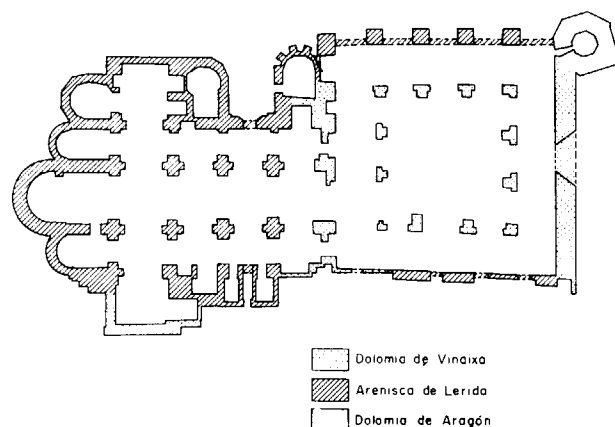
Esquema en planta de la Seu Vella con la distribución de las litologías utilizadas en su edificación.
